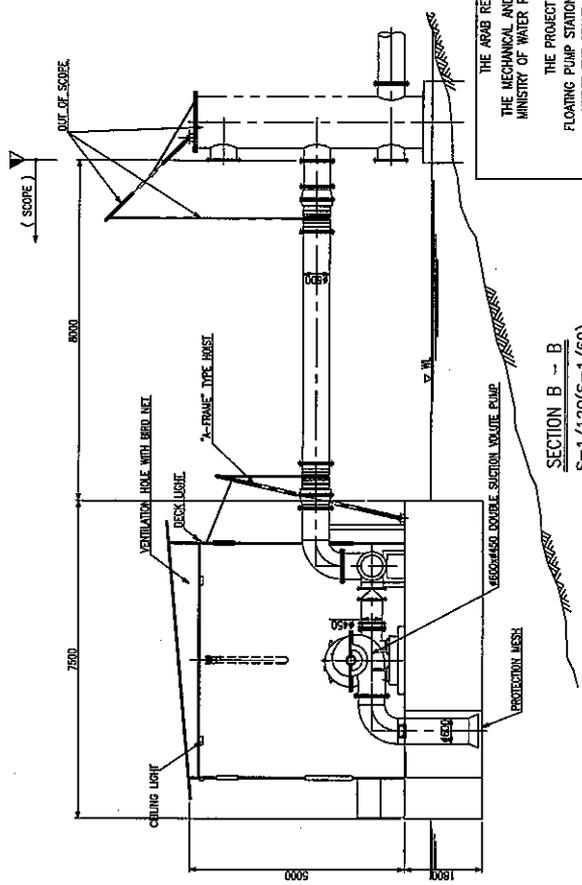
フローティングポンプ場平面図・断面図 (No.34)
